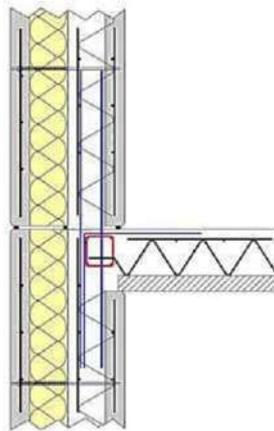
Plancher suspendu avec attentes mises sur chantier
